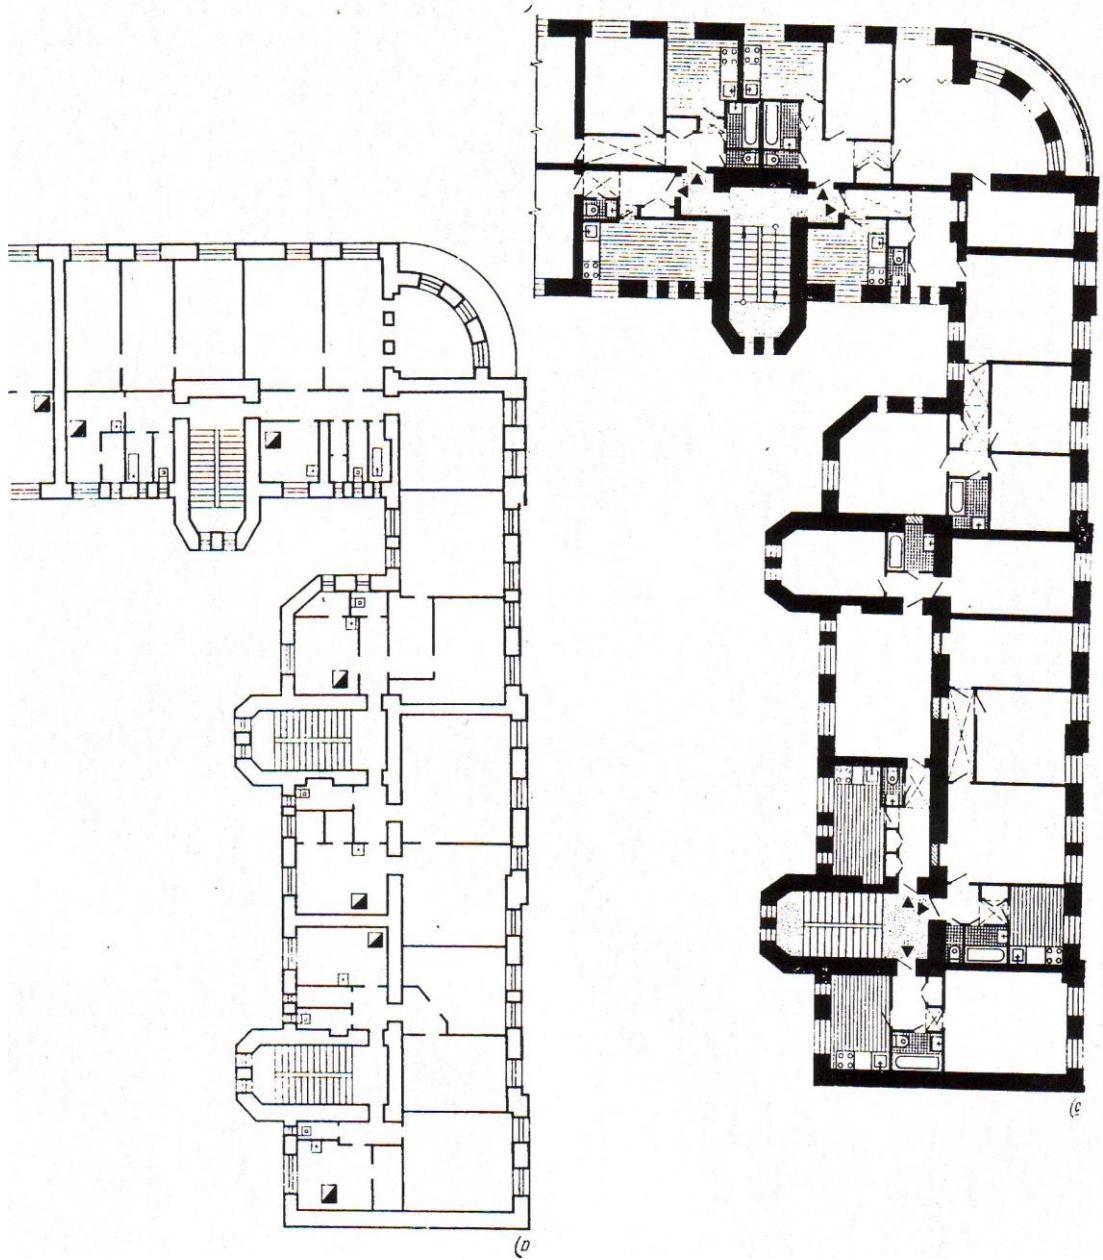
Вариант перепланировки углового решения жилого здания с ликвидацией части лестниц: а — до реконструкции; б — после реконструкции
